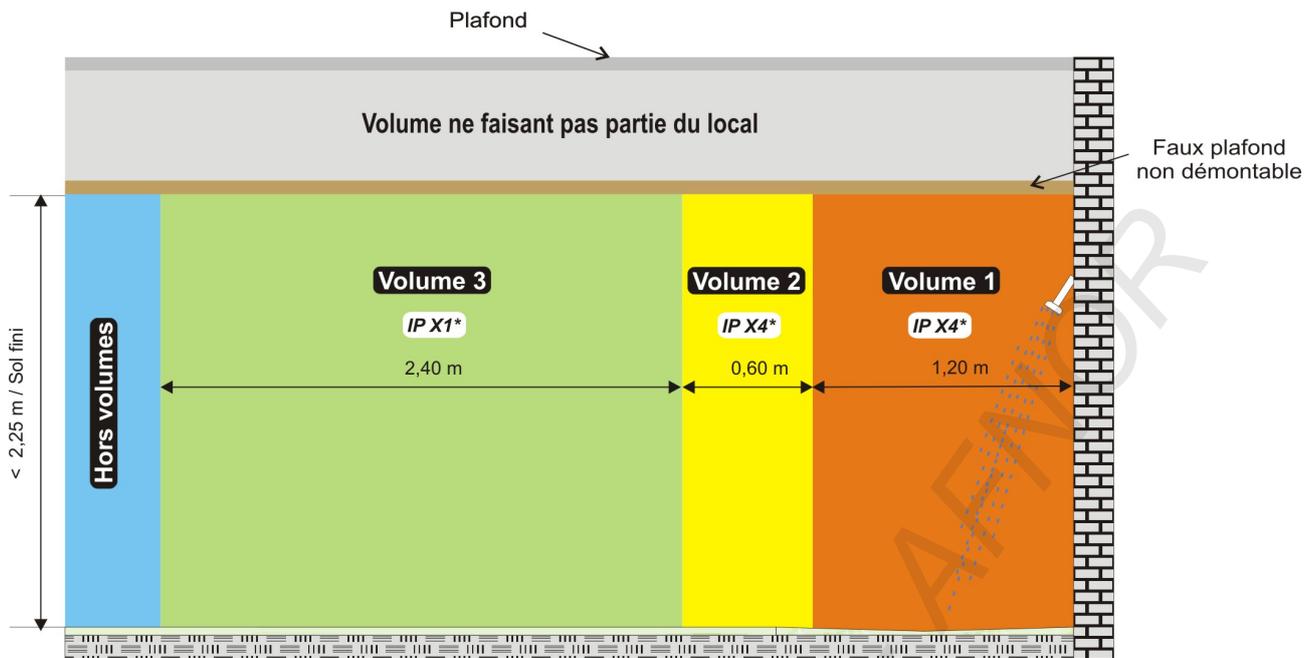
R – Faux plafond non démontable situé à moins de 2,25 m du fond du receveur ou de la baignoire
